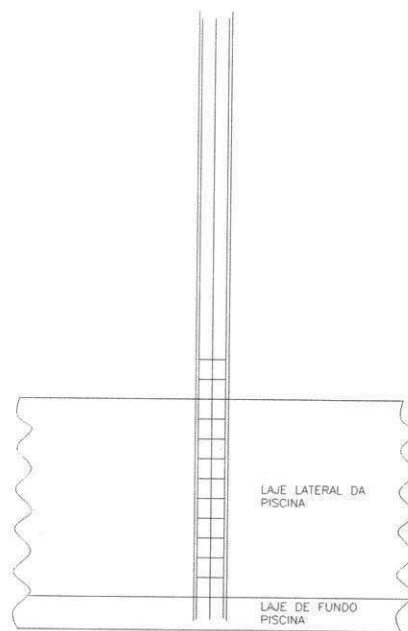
Detalhe do pilar engastado na laje de fundo da piscina
